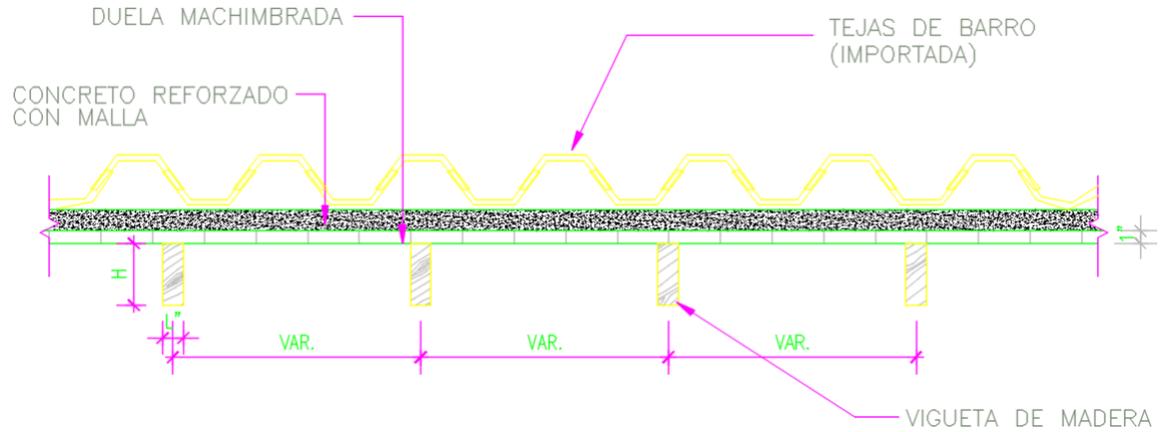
Detalle 3 de Cubierta en machimbre, elaboración propia
